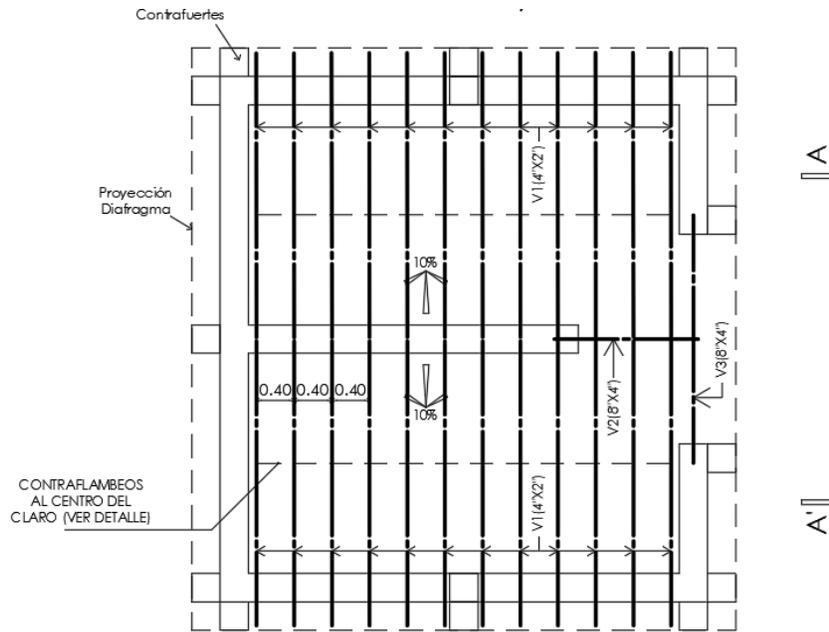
Plano de la segunda propuesta de cubierta para baños. Imagen propiedad del autor.
